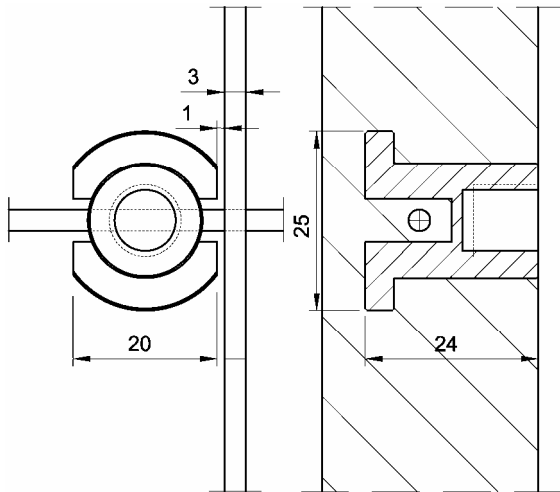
Detalle de posicionamiento del casquillo respecto a las armaduras en el panel prefabricado.
